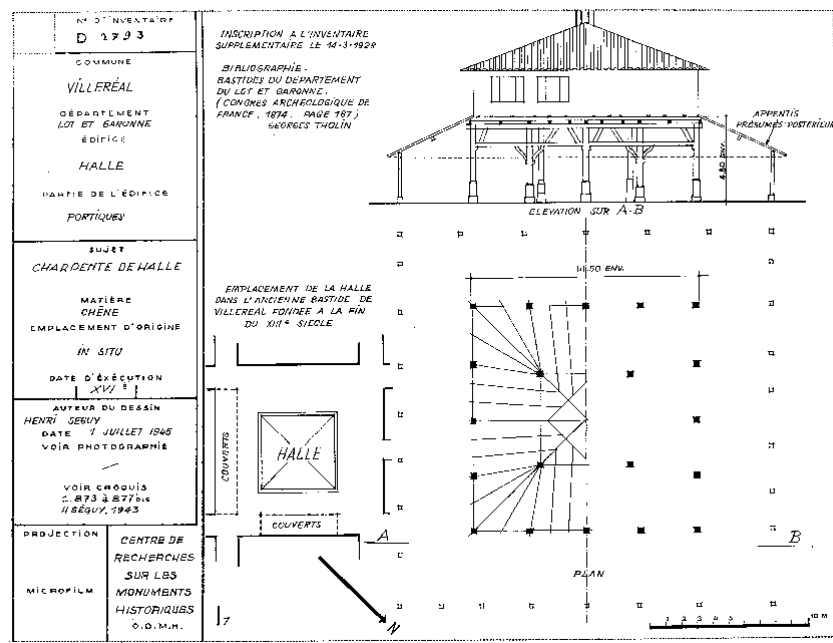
Relevé géométrique (1943-1945) de la halle par Henri Séguy montrant la disposition en plan des poteaux et une vue d'élevation de la structure (Ministère de la Culture, 1943)
